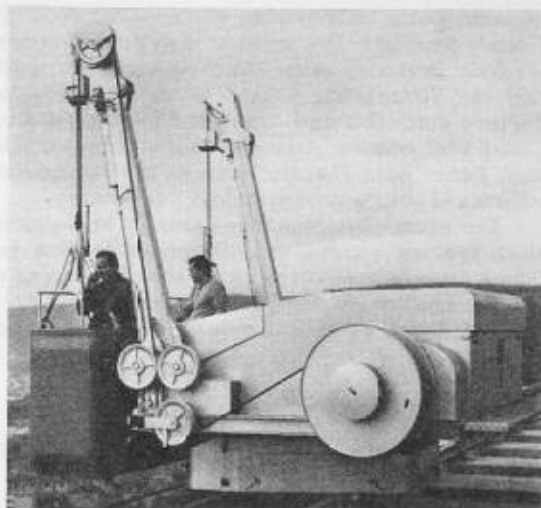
(rechts). Fassadenreinigungsanlage, auf dem Dach des Hochhauses montiert
